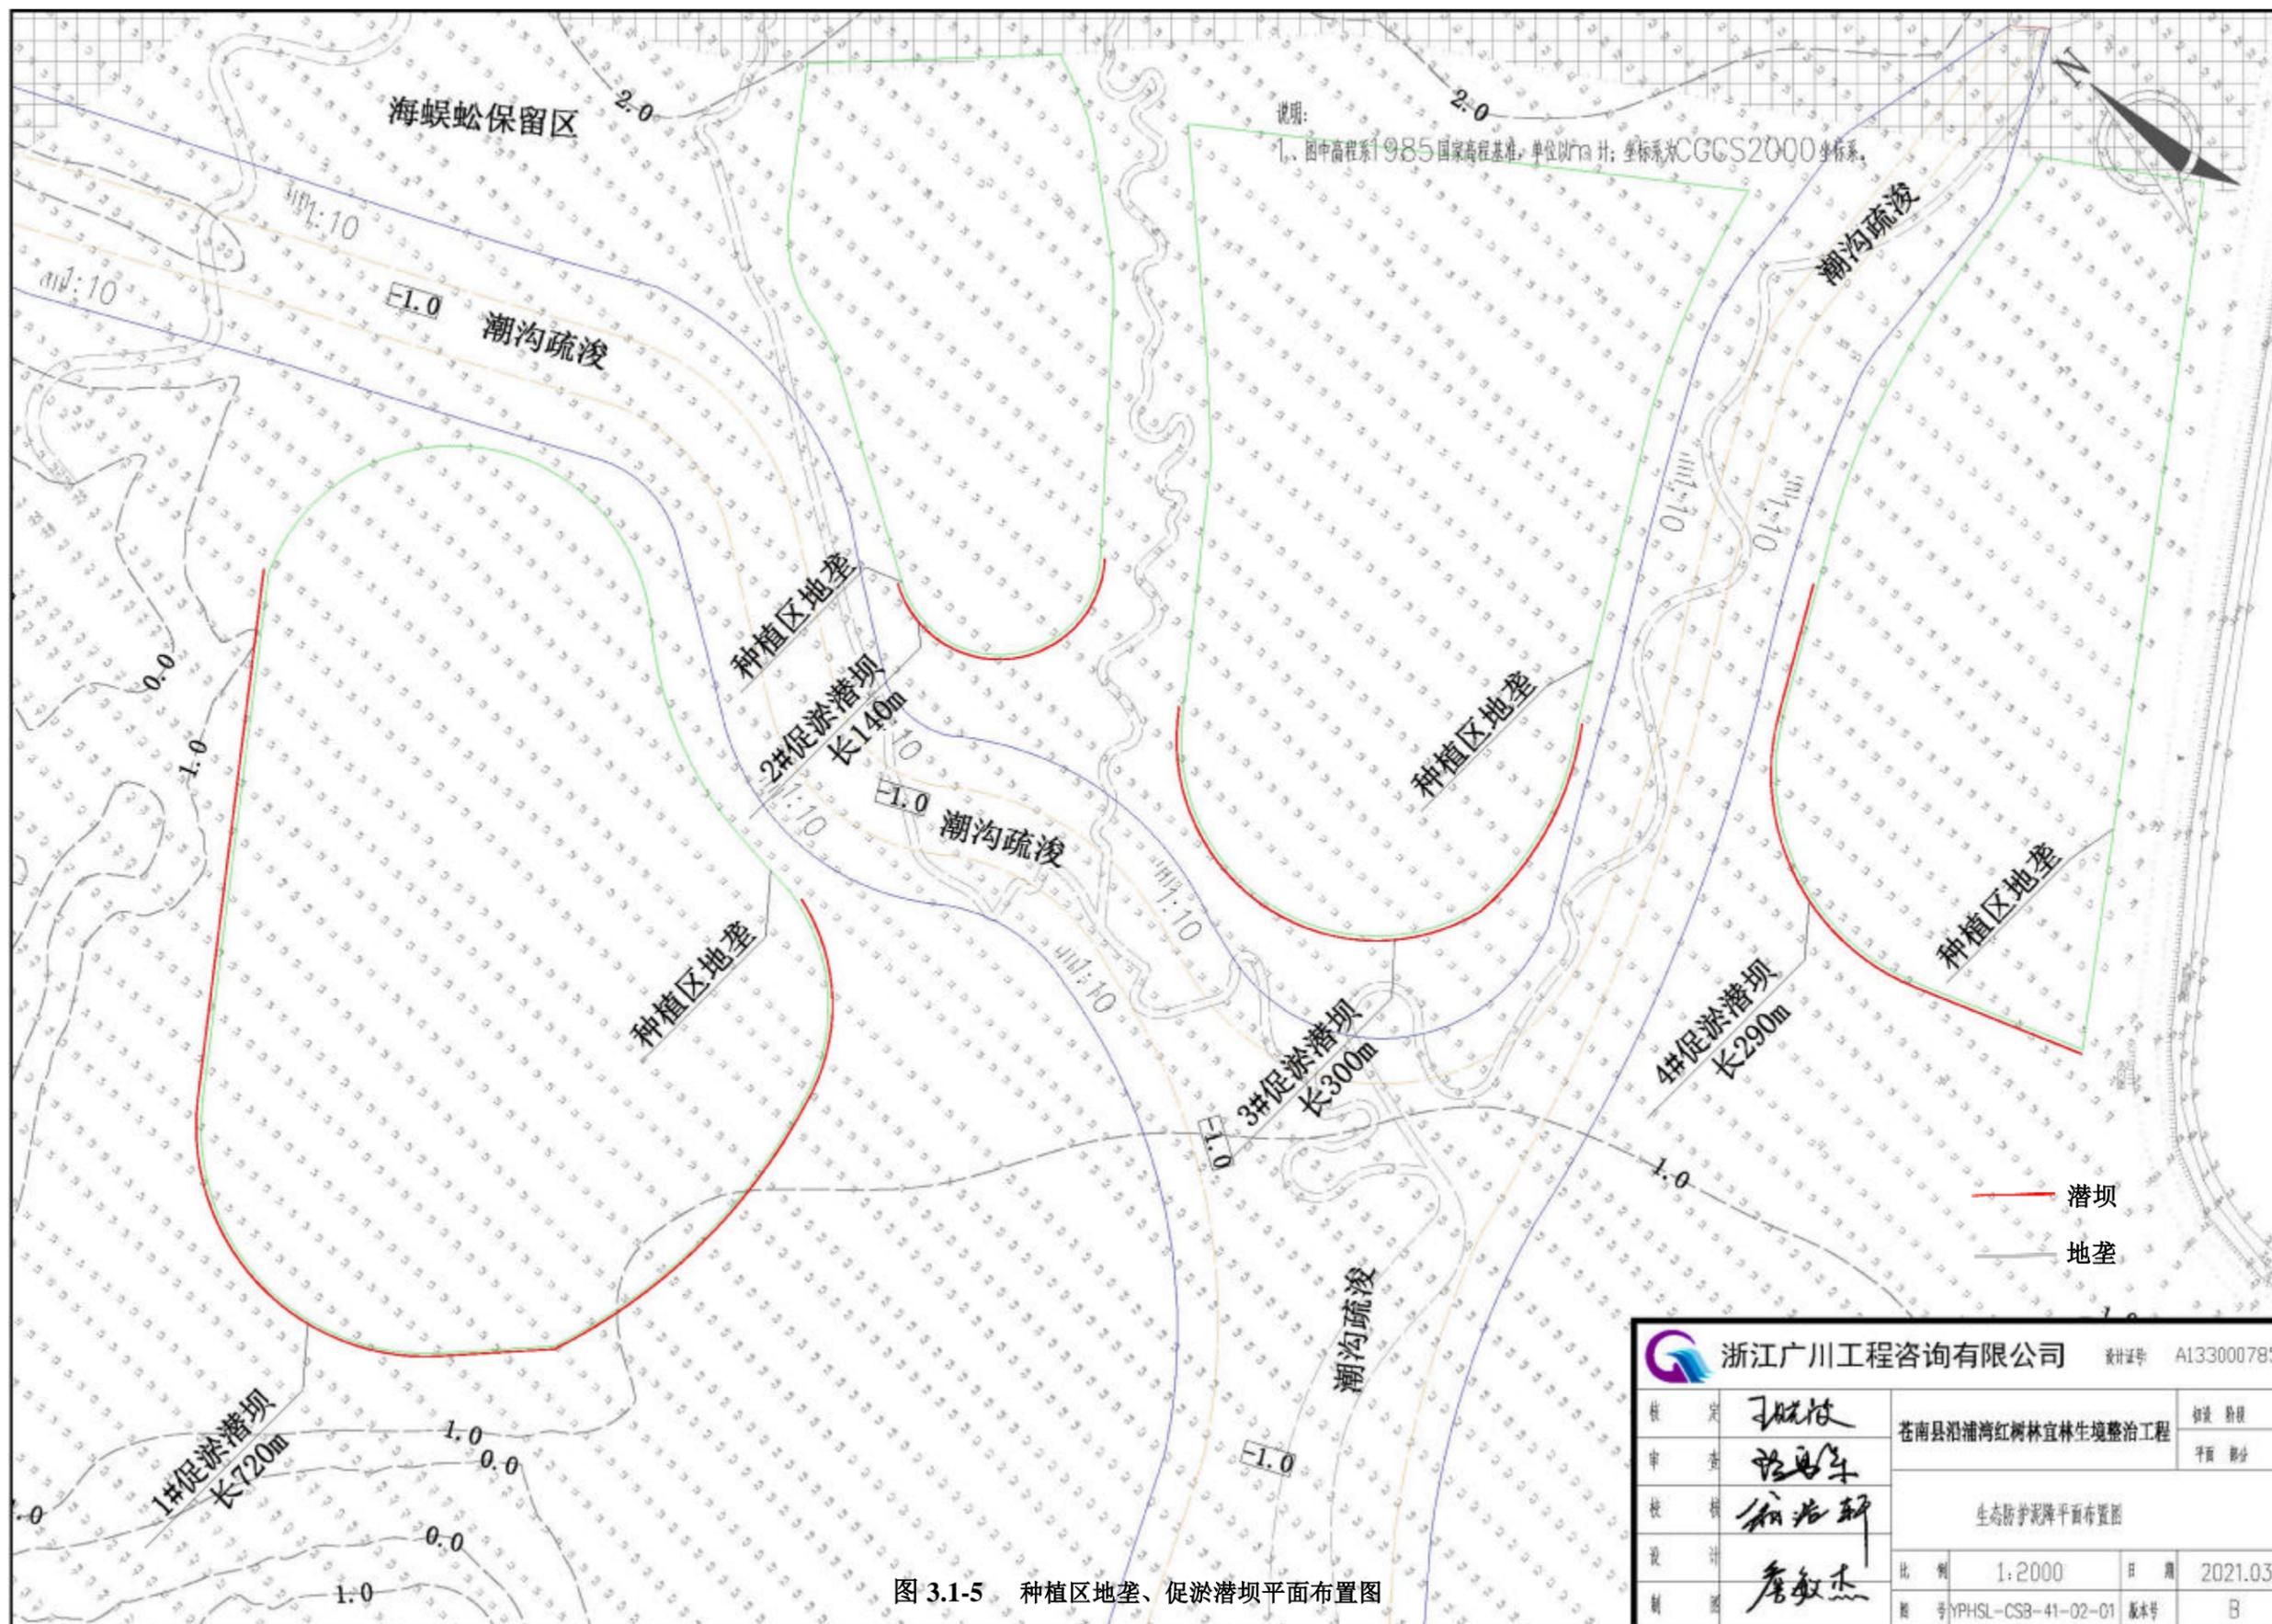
种植区地垄、促淤潜坝平面布置图
